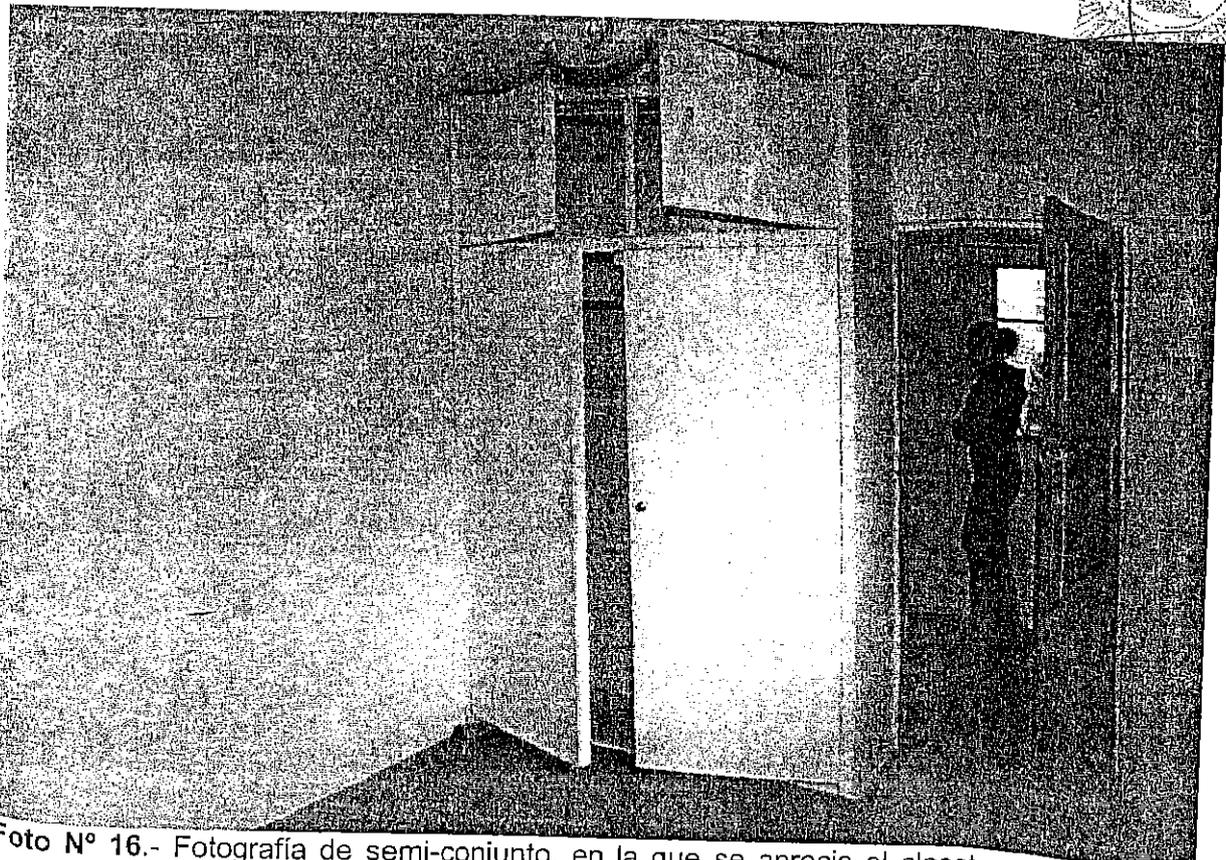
Fotografía de semi-conjunto, en la que se aprecia el closet empotrado en la pared del cuarto de la segunda planta.
